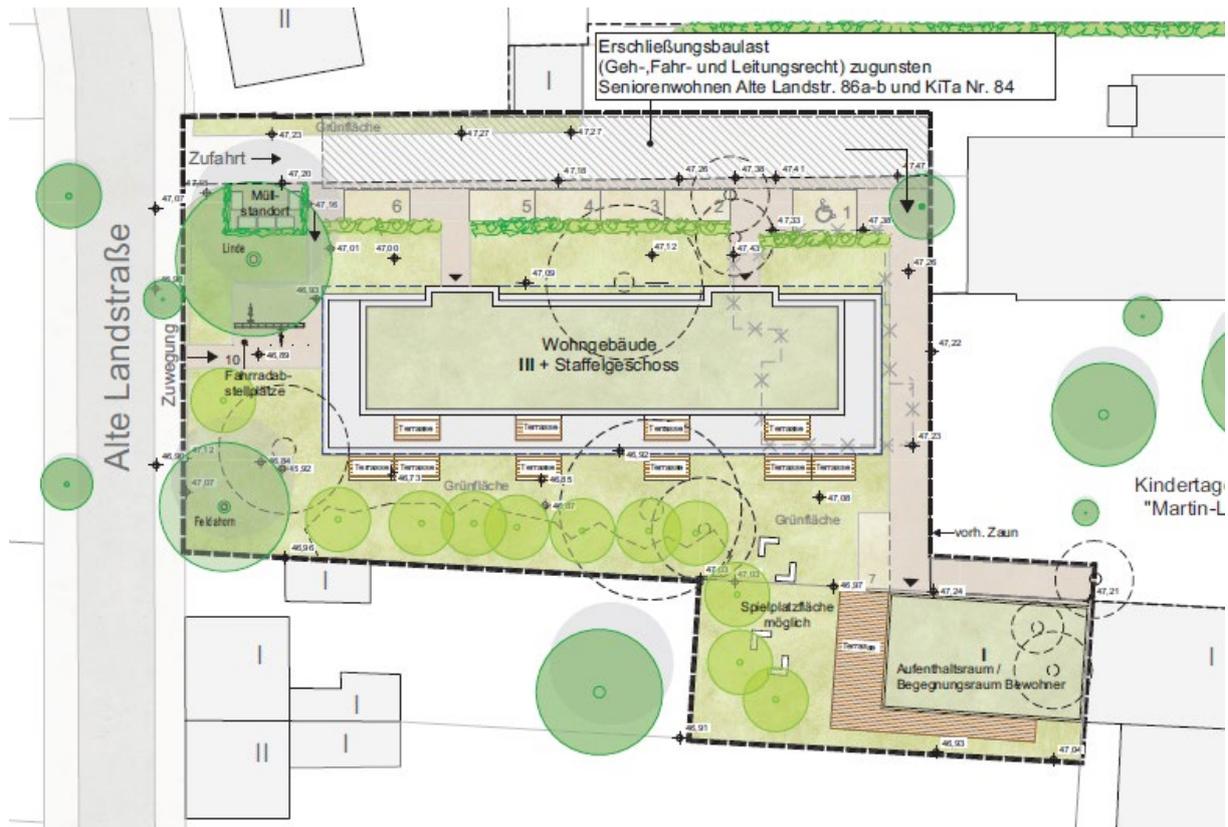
Städtebaulicher Entwurf, Variante B, Lageplan – ohne Maßstab
